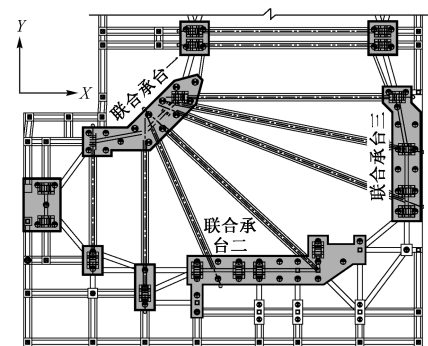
阙楼暗挖顶管预应力拉杆平面布置图
